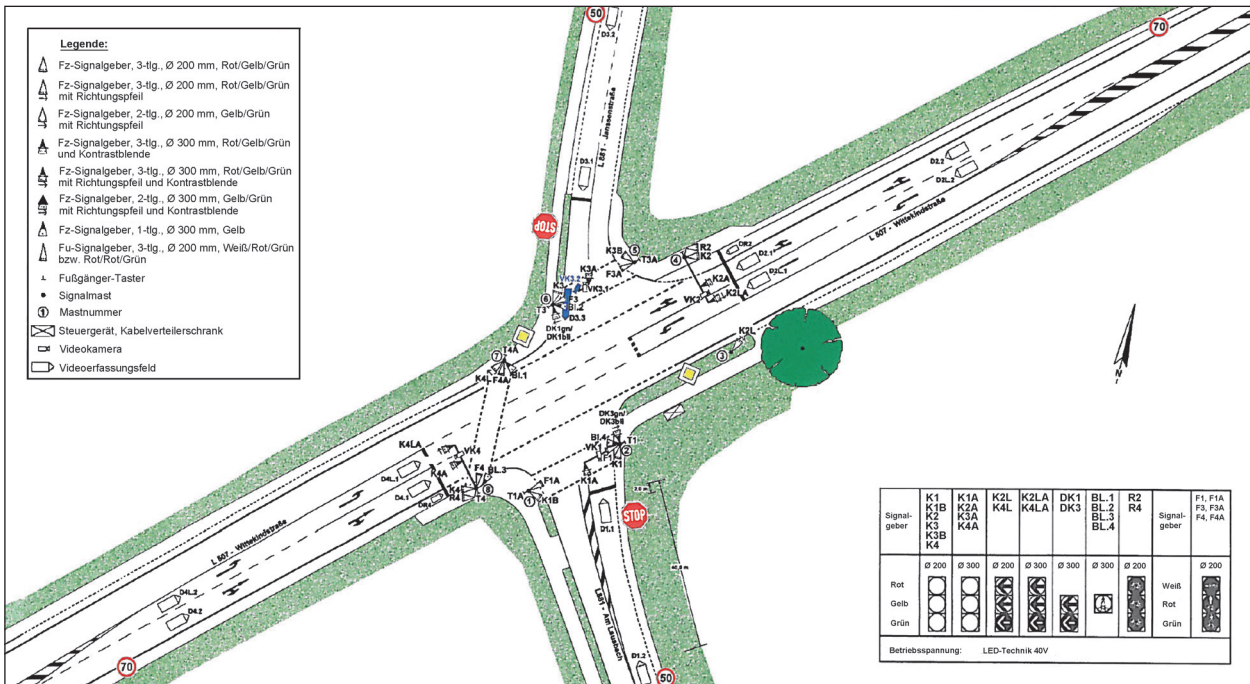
Signallageplan des Knotenpunkts Wittekindstraße/Janssenstraße/Am Lausbach in Hamm
